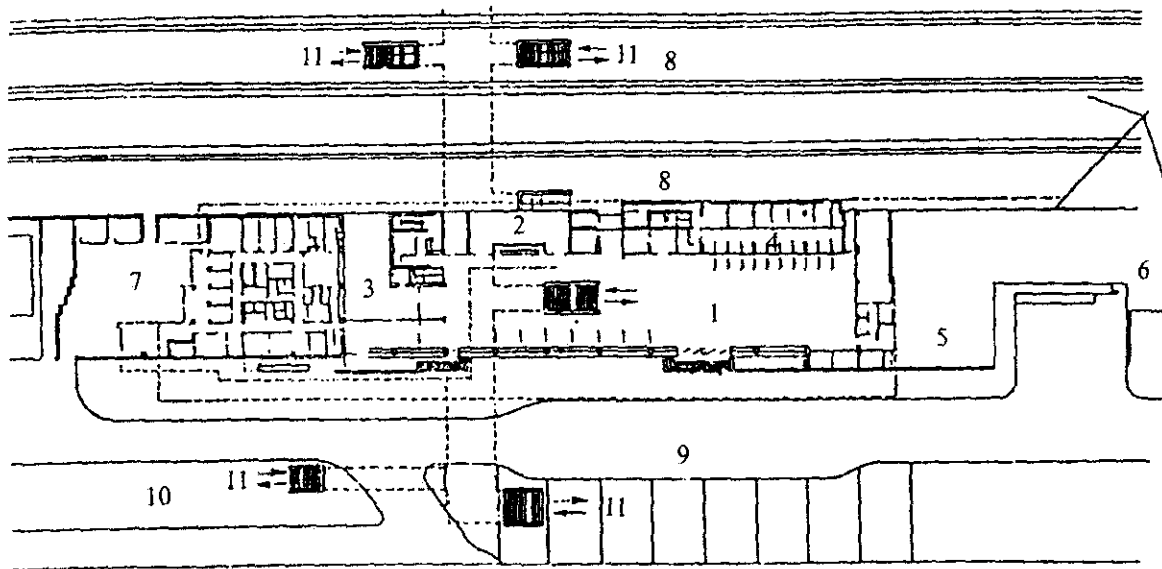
Совмещенный узел пересадки метрополитен – железная дорога
